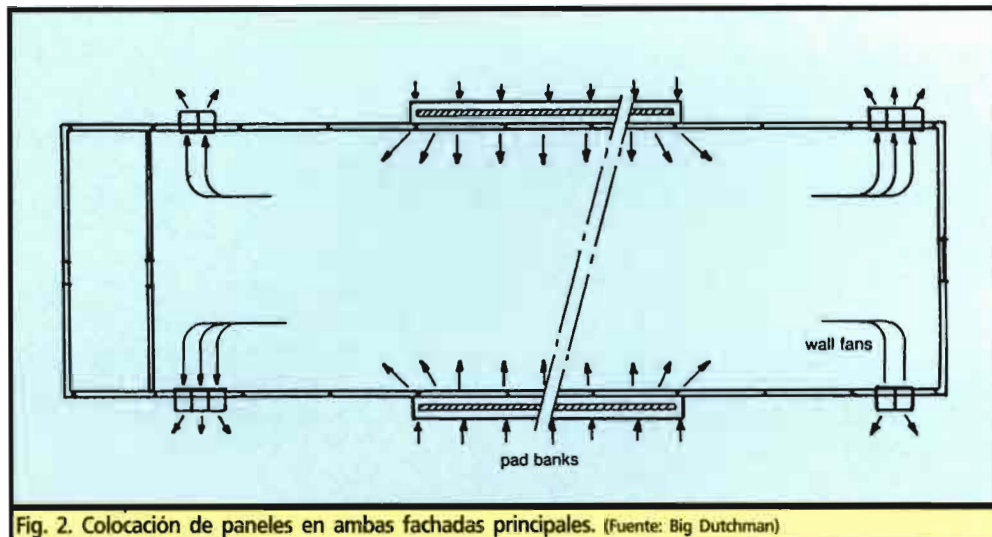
Colocación de paneles en ambas fachadas principales. (Fuente: Big Dutchman)
